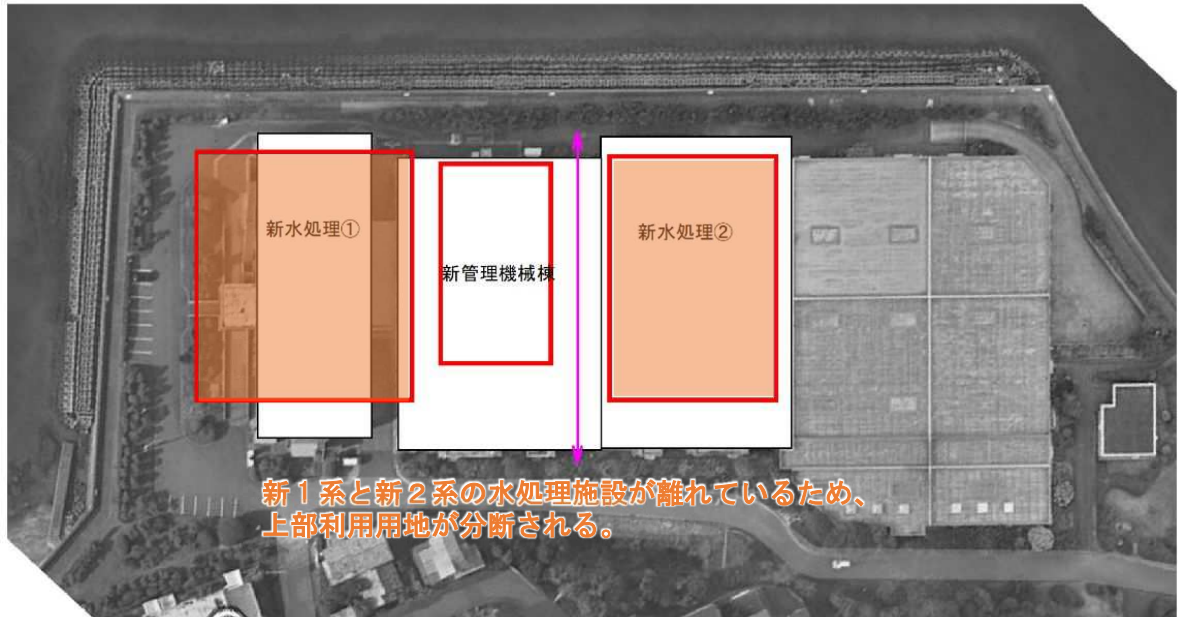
1系水処理施設から先に撤去した場合の配置図
